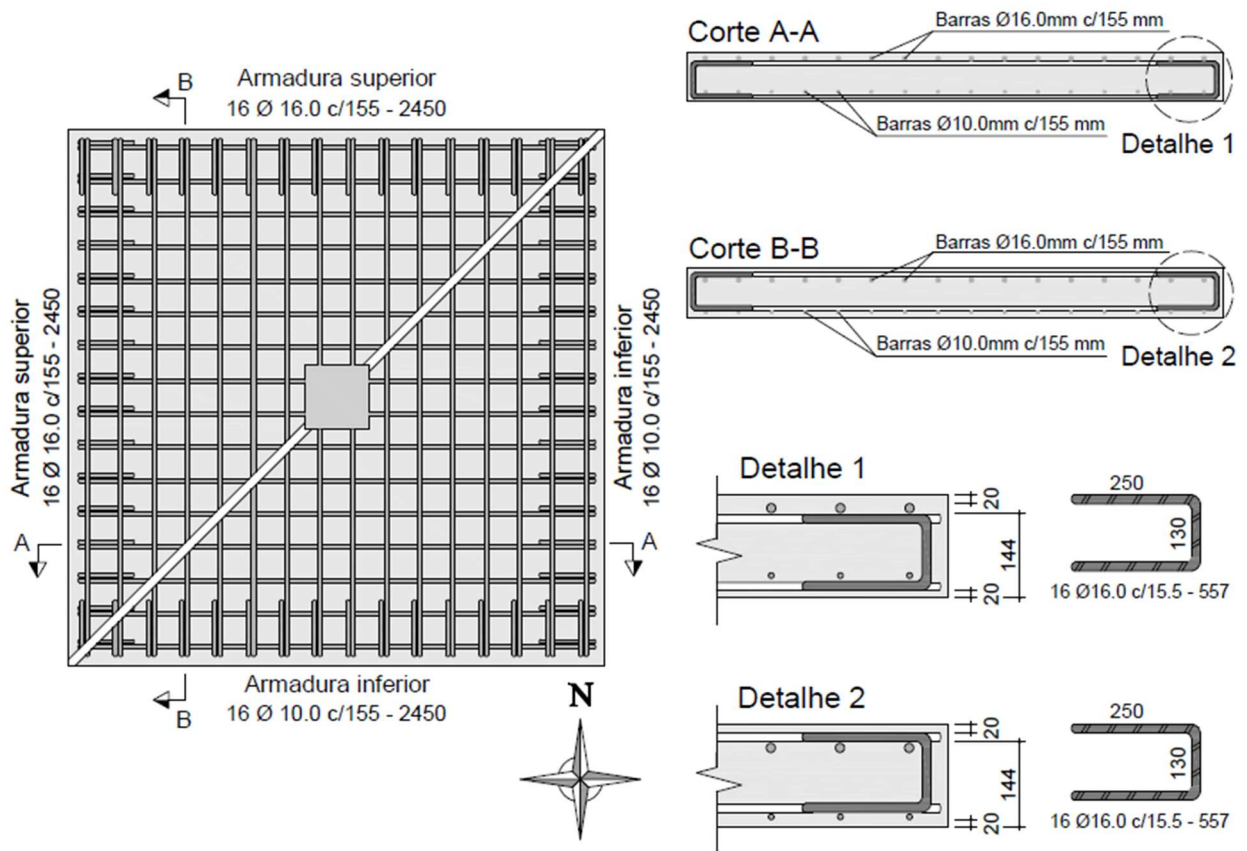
Detalhamento das armaduras de flexão da laje RSP, adaptado de Palhares (2018)
